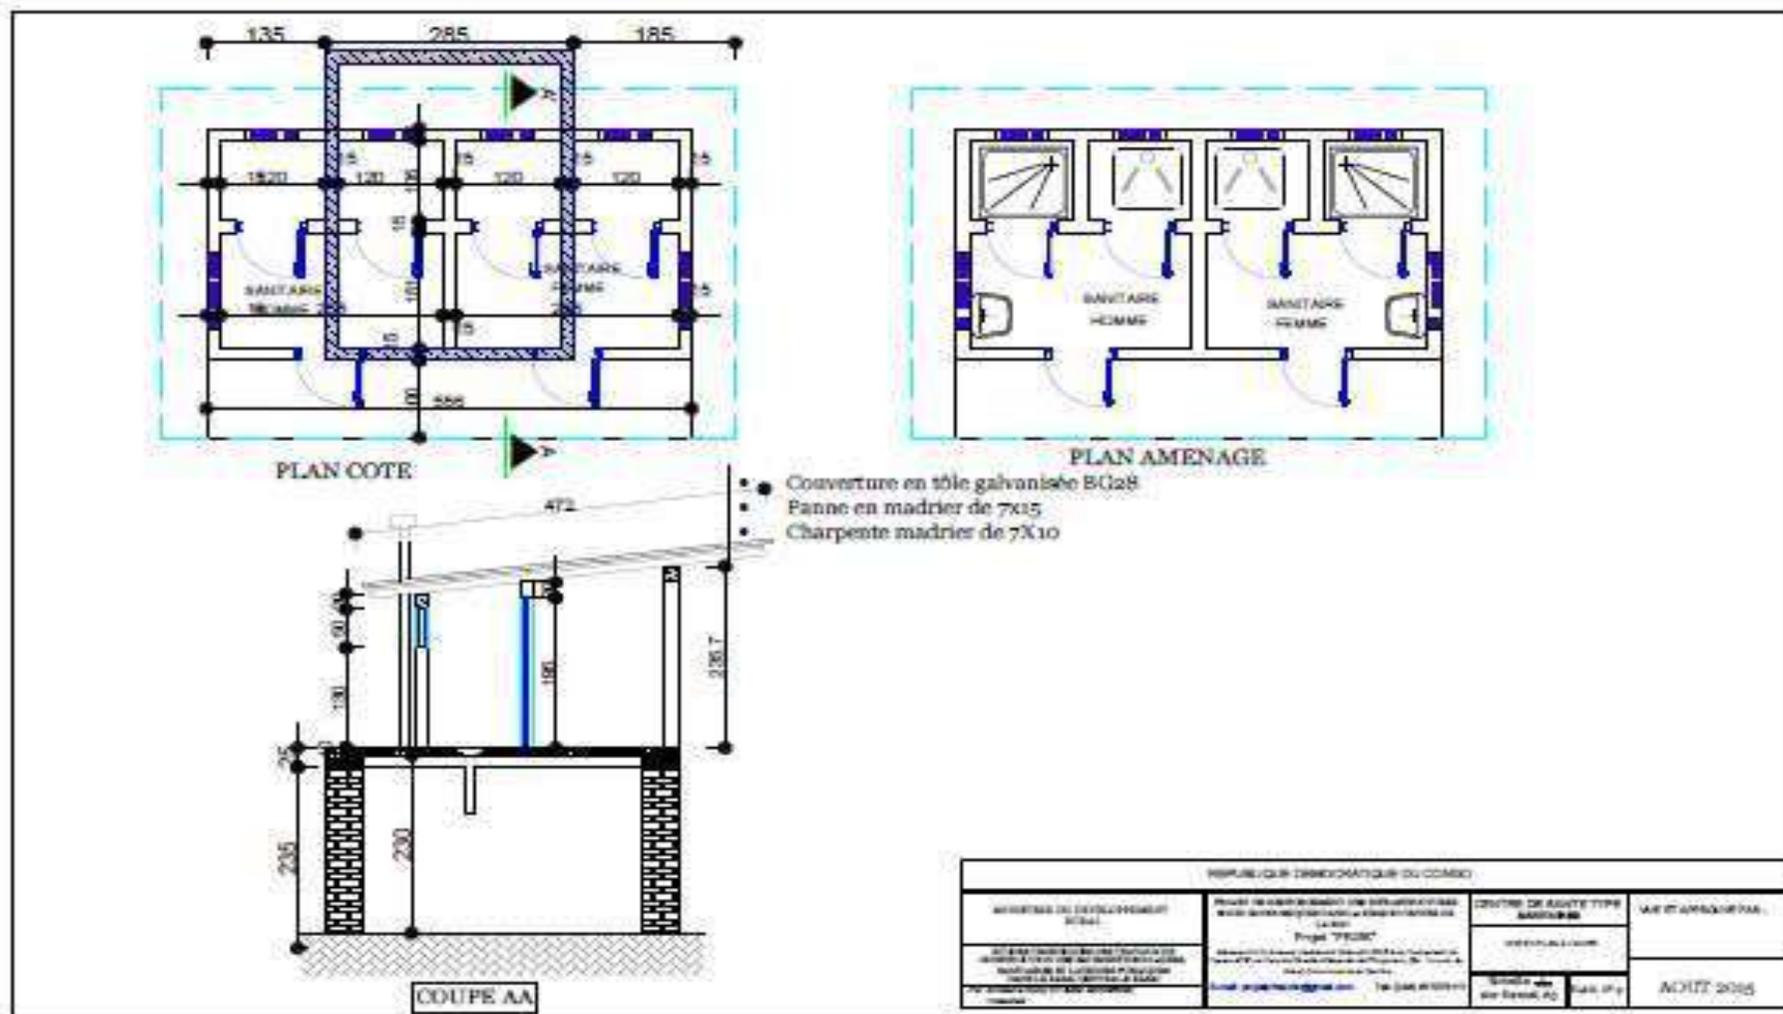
Le plan aménagé des sanitaires qui seront construits sur les sites des centres de santé
